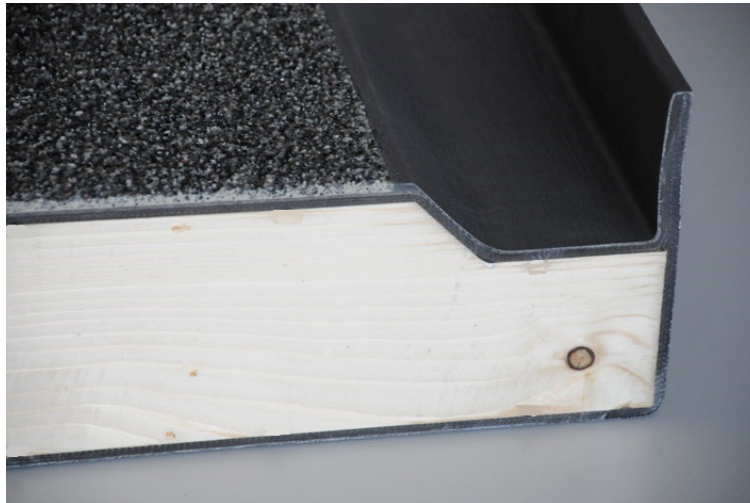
Muster eines dauerhaften Holzelementes mit Ablaufrinne und Flansch
